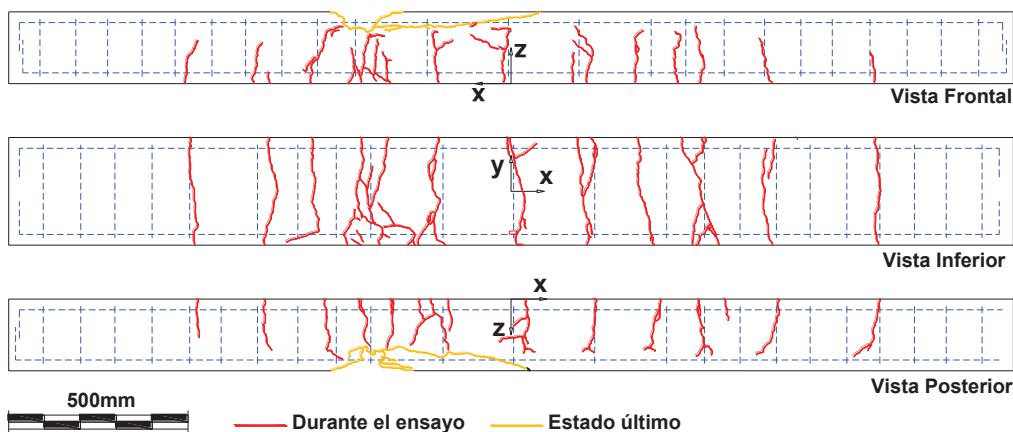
Esquema del patrón de agrietamiento de viga de control.
